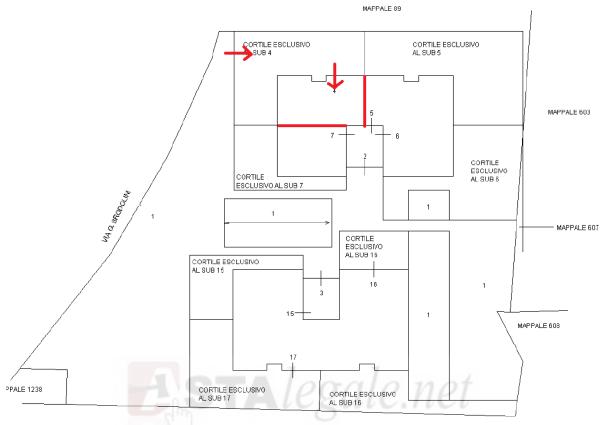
Pianta del p. t. del complesso edilizio con indicazione dell'appartamento pignorato e dei suoi accessi (tratta dall'elaborato planimetrico catastale)
